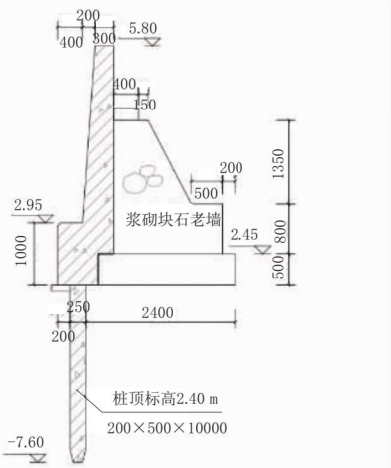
浦东防汛墙断面图(长度单位:cm;高程单位:m)
